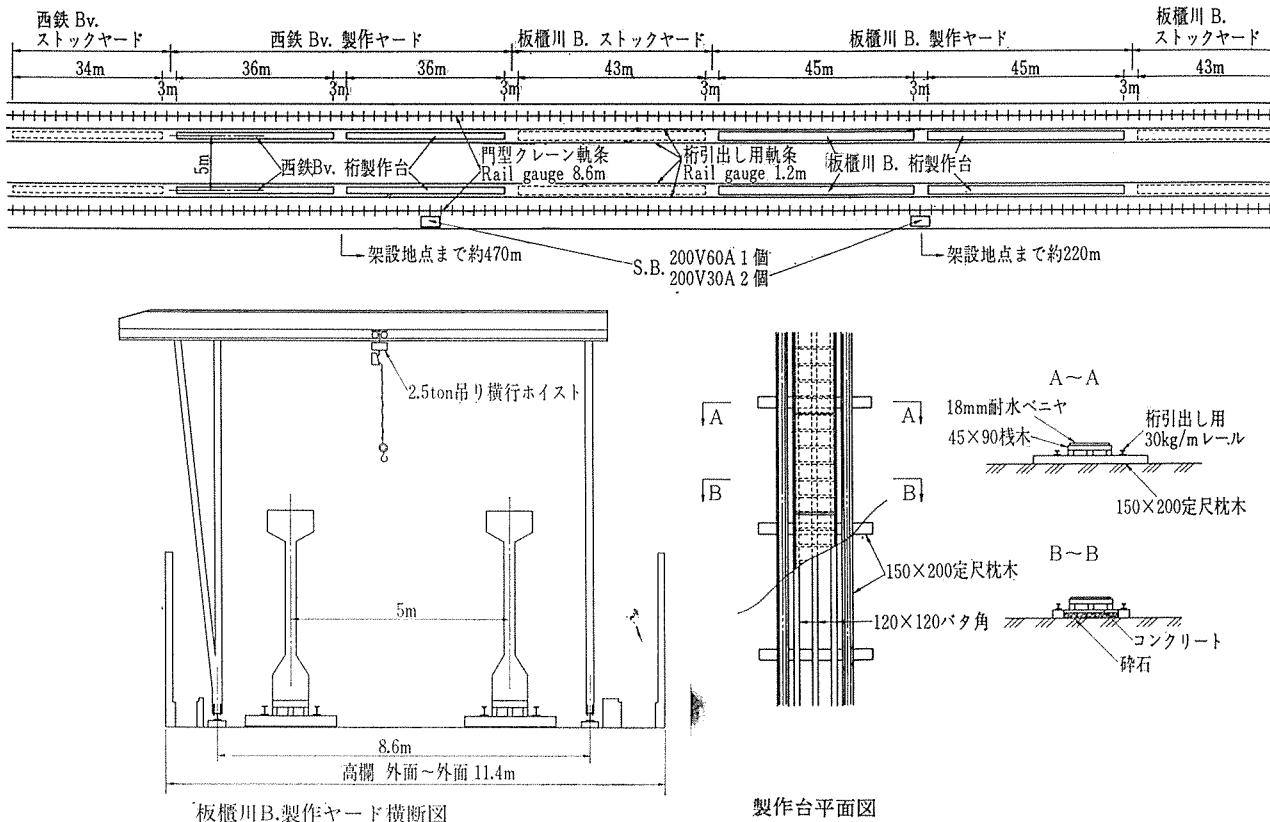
西鉄 Bv, 板櫃川 B 製作ヤード平面図
